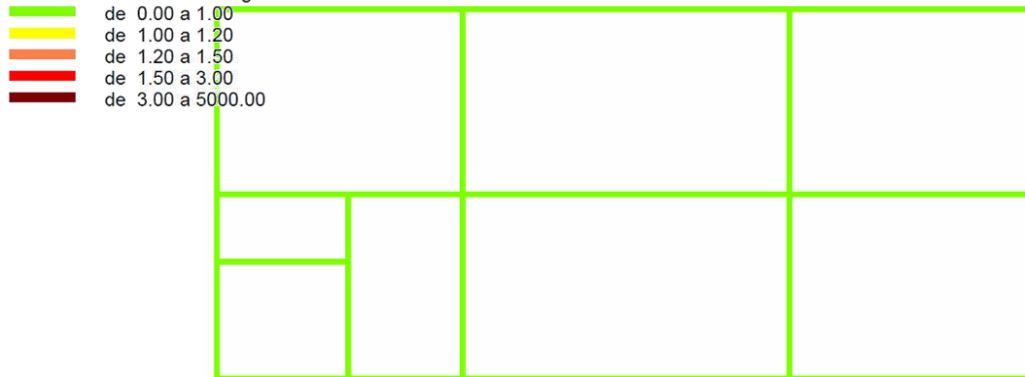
Índice de sobreesfuerzo en Vigas a Cortante – Primer nivel
